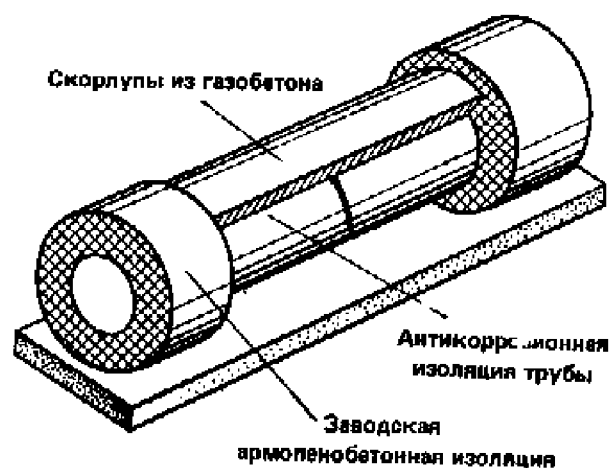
Теплоизоляция газобетоном или армопенобетоном
